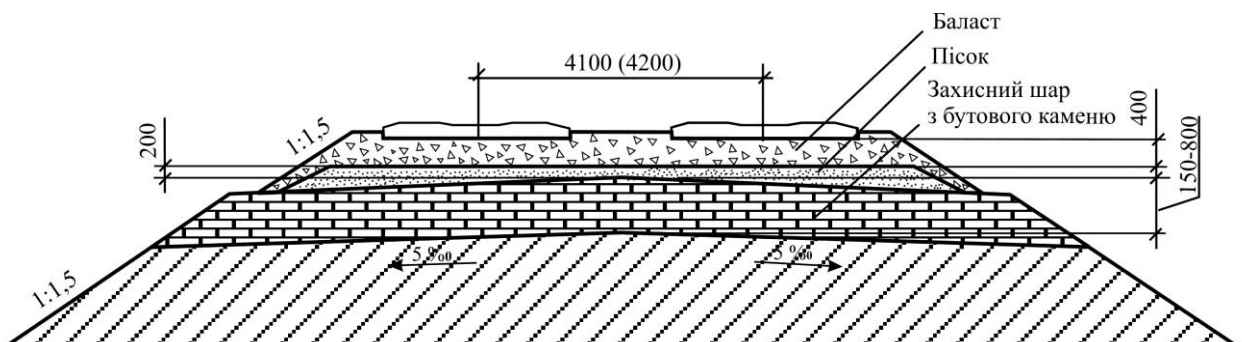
Конструкція земляного полотна із захисним шаром із бутового каменю
